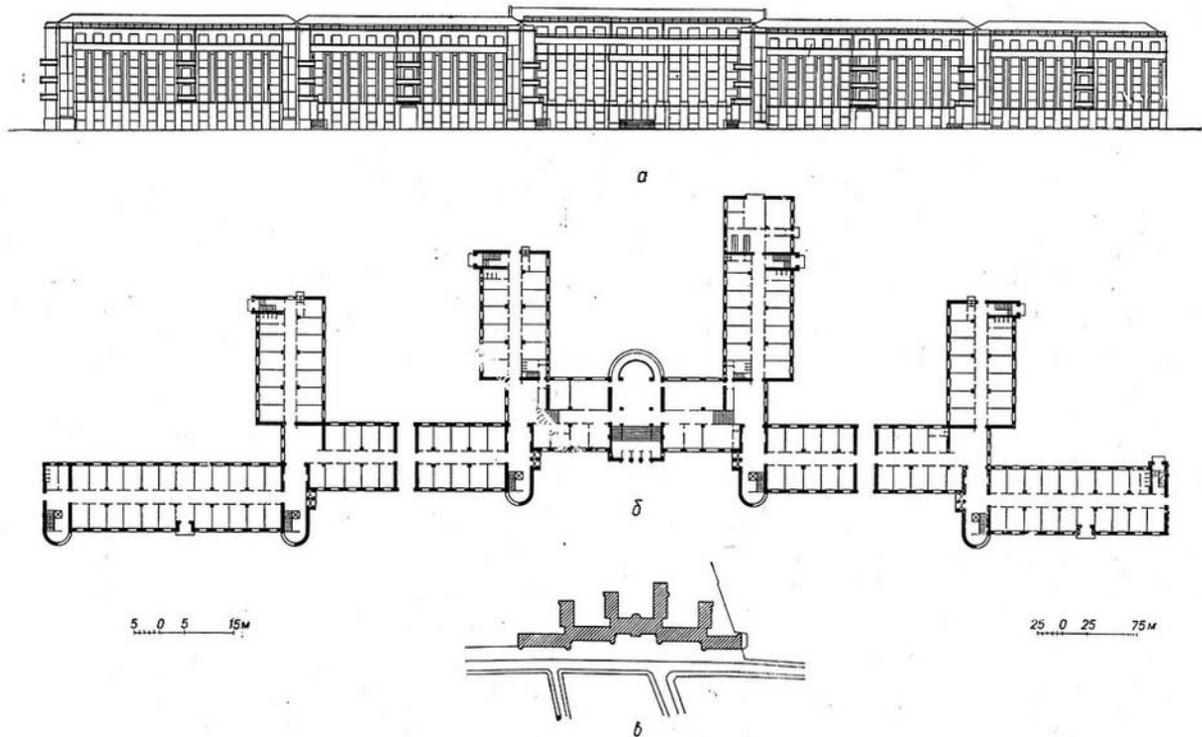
Здание «Дом пролетарского студенчества № 1». Главный фасад, план, схема генплана
